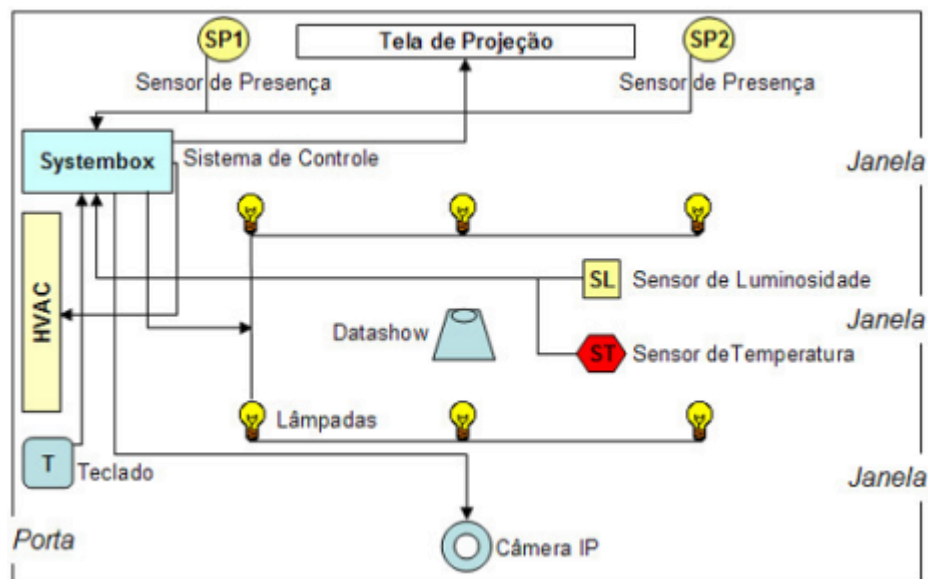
Planta baixa da sala 301-A – Adaptado de (PEROZZO, 2011).
